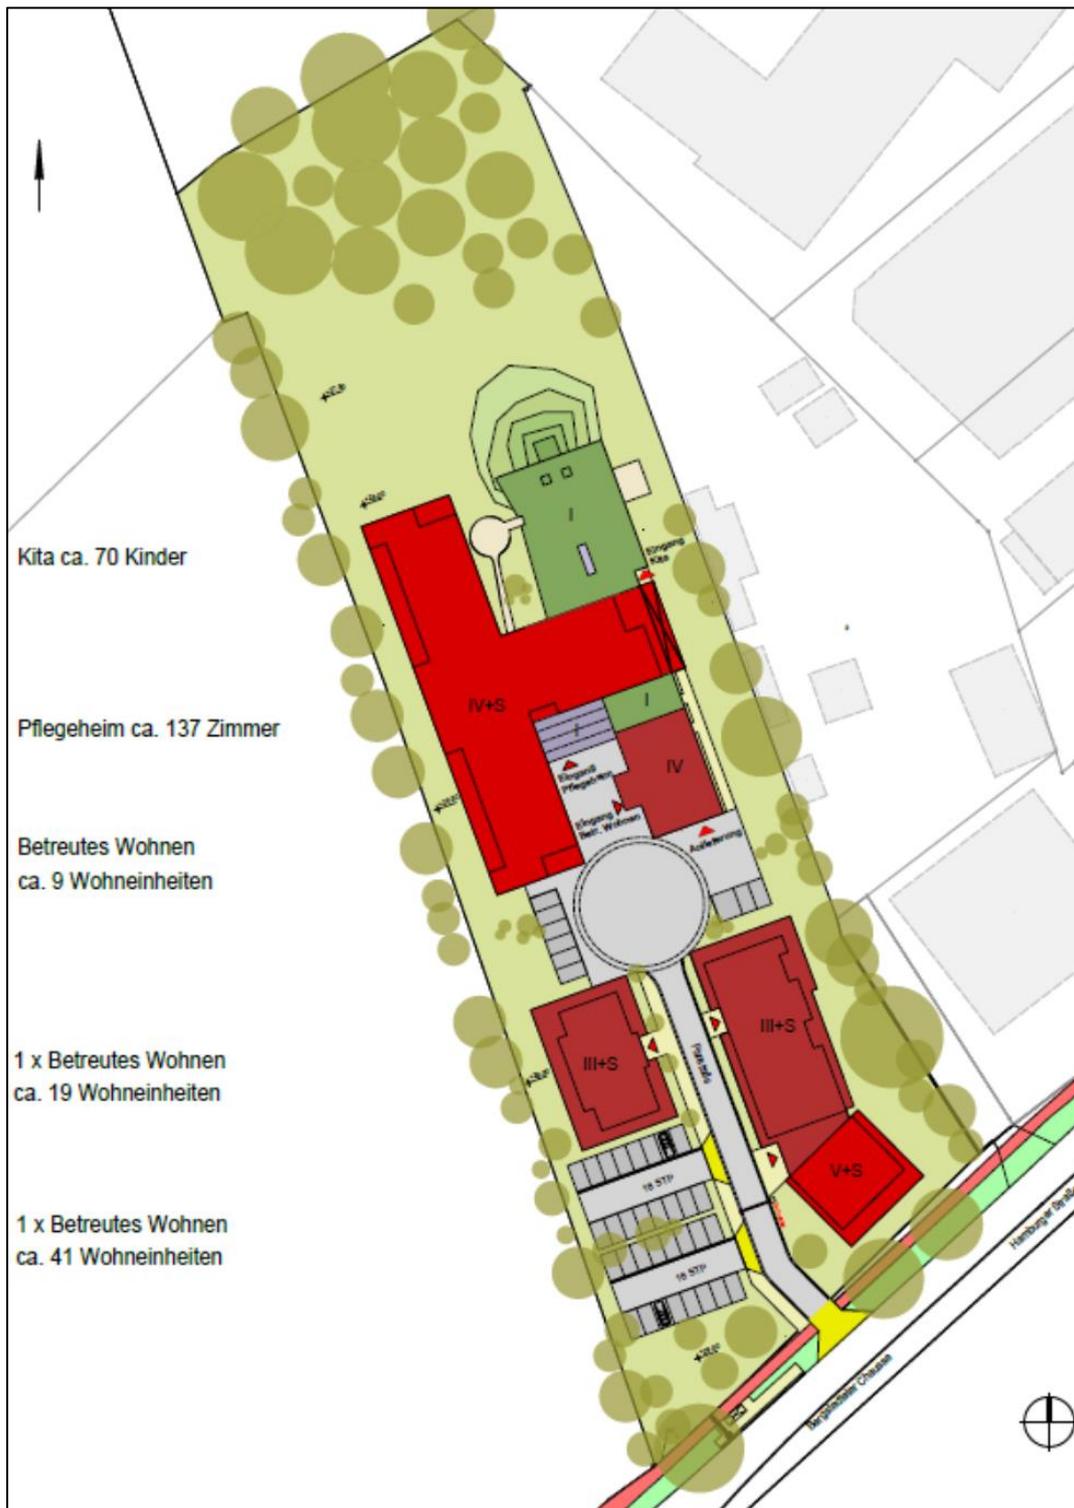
Funktionsplan (Ulrich Salzmann Architekt, Stand: 12.01.2021)
